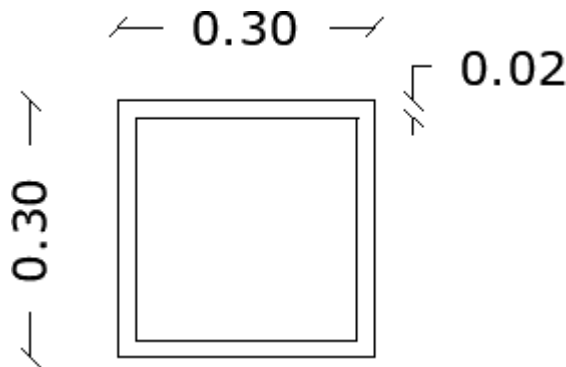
Sección de columna metálica. [Elaboración propia]
